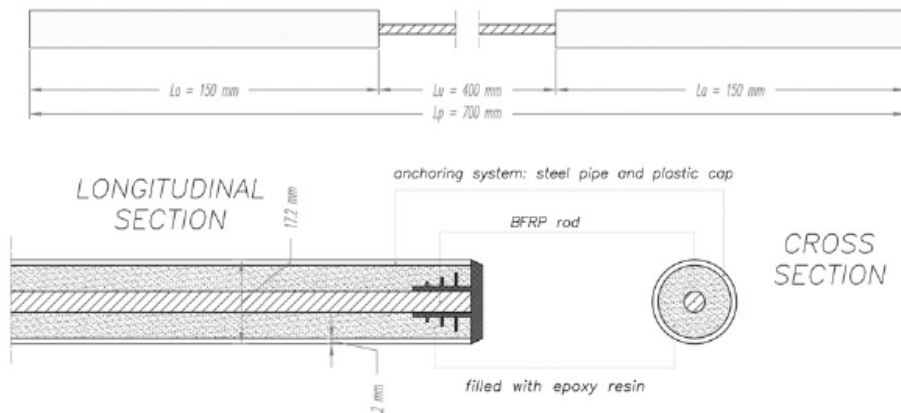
Dimensiones y detalles del sistema de anclaje de varillas de BFRP⁴⁸
